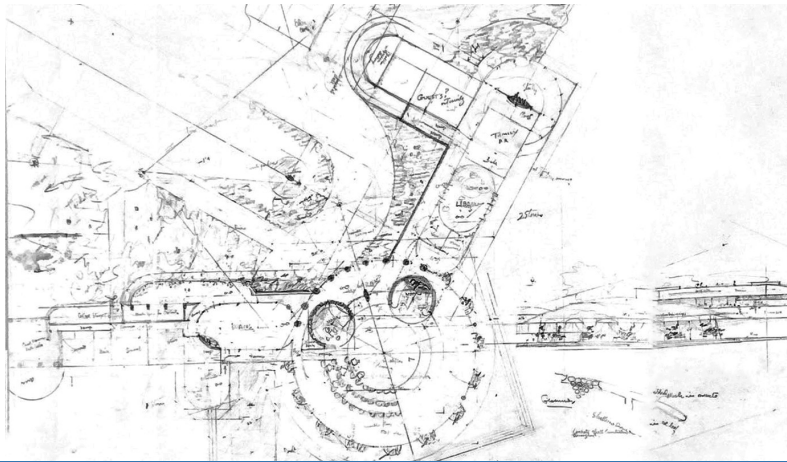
Planta baja de la Casa Baillères. Realizado por Frank Lloyd Wright.
